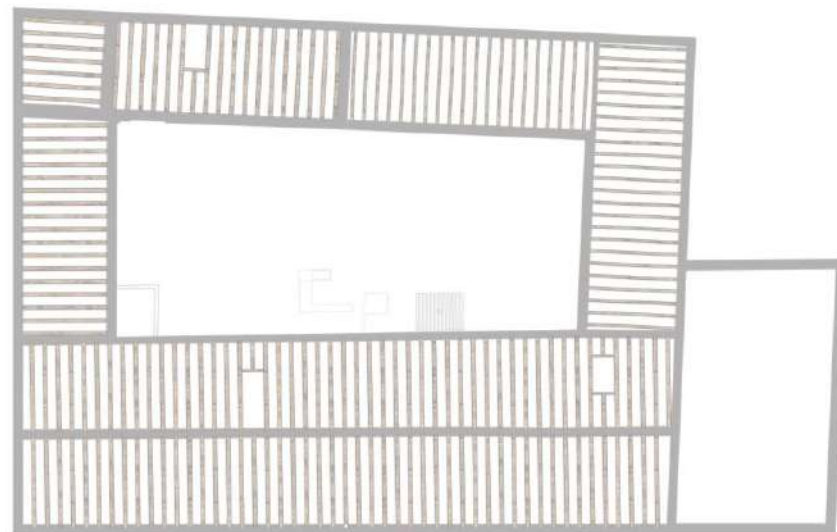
Plano estructural de forjado 1. Fuente: Propia
